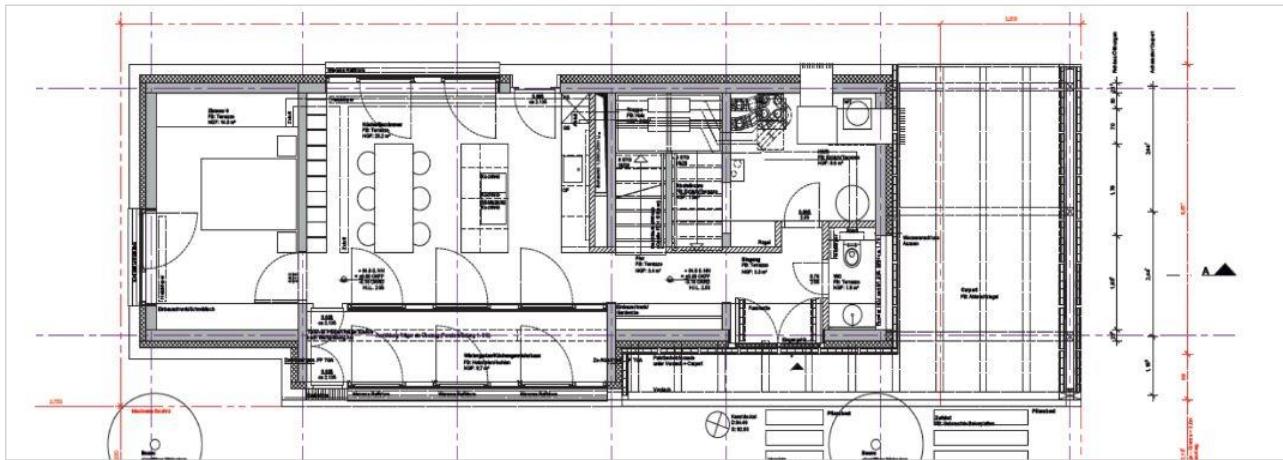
Grundriss des Recyclinghauses am Kronsberg
